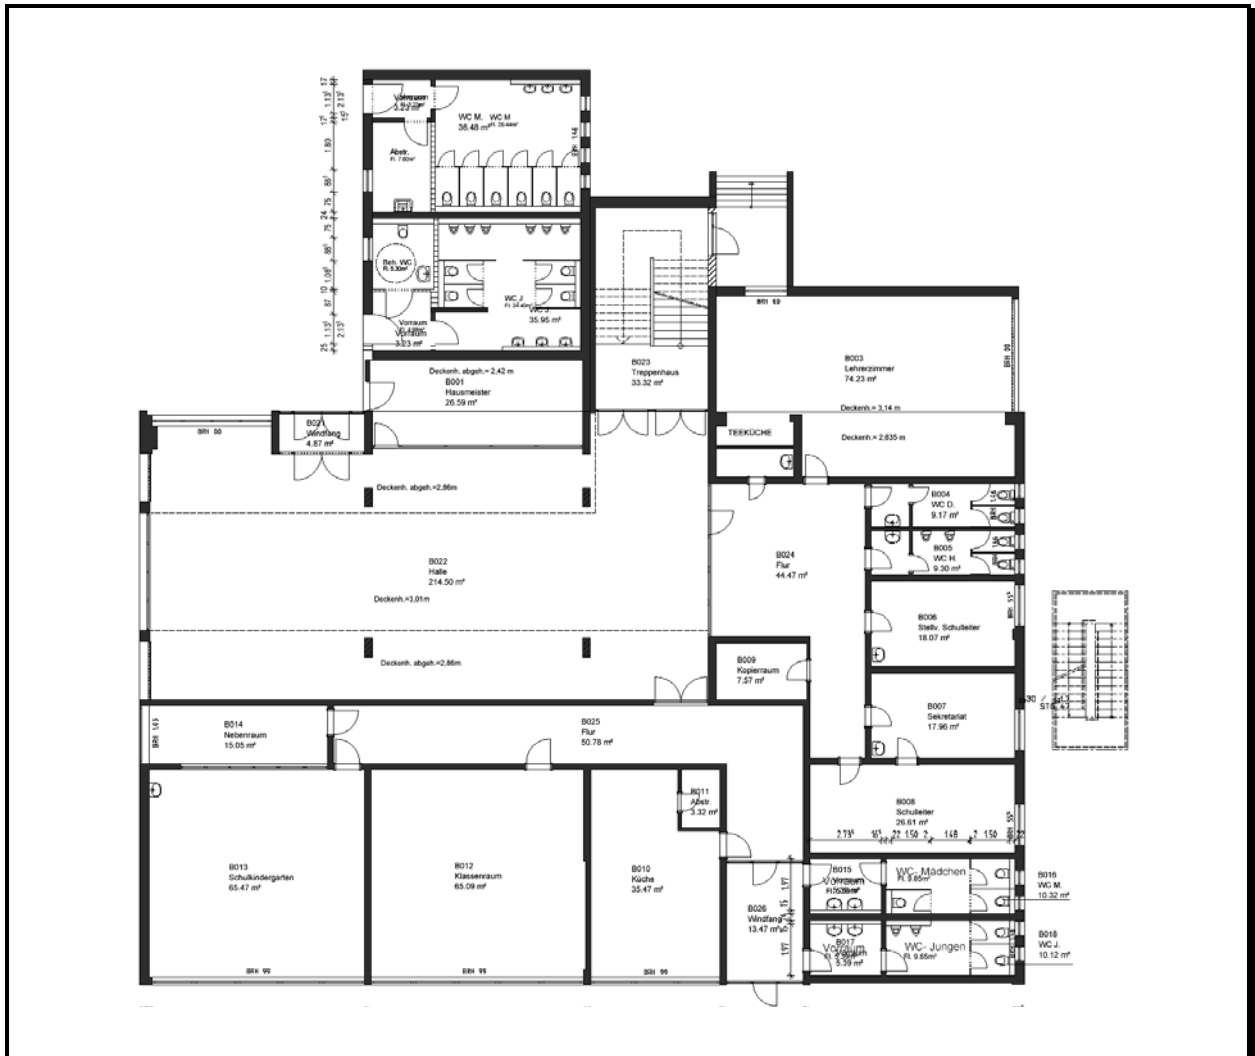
Deutscherrenschule: Grundriss Erdgeschoss Bauteil B
